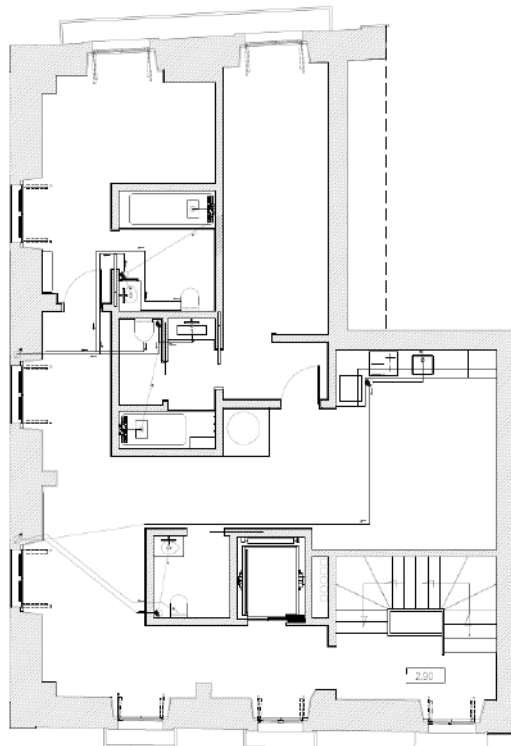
Planta de Sistema de Drenagem Predial de Águas Residuais - Piso 1
